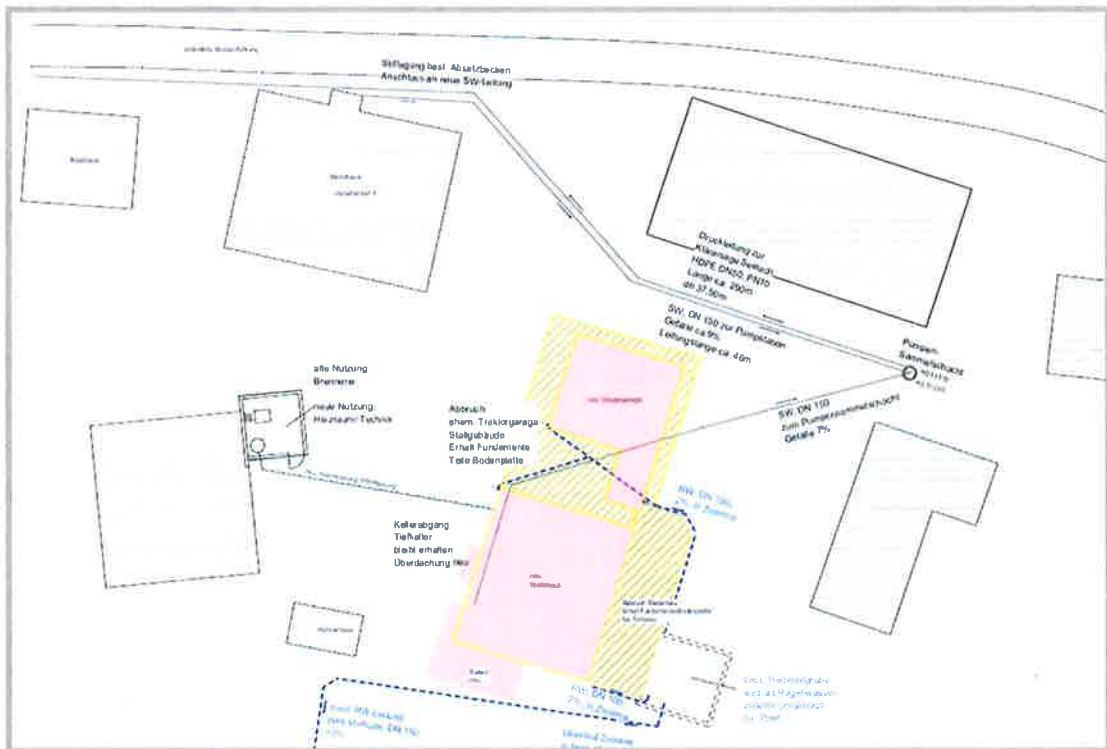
Lageplan Bauvorhaben unmaßstäblich (Quelle: T. Bräuning)
